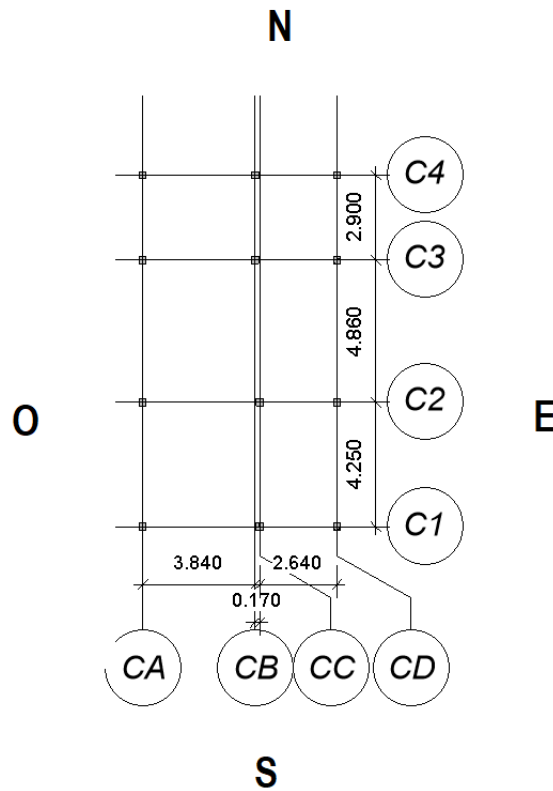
Vista en planta de los pilares de la casa del conserje y la distancia entre ellos
